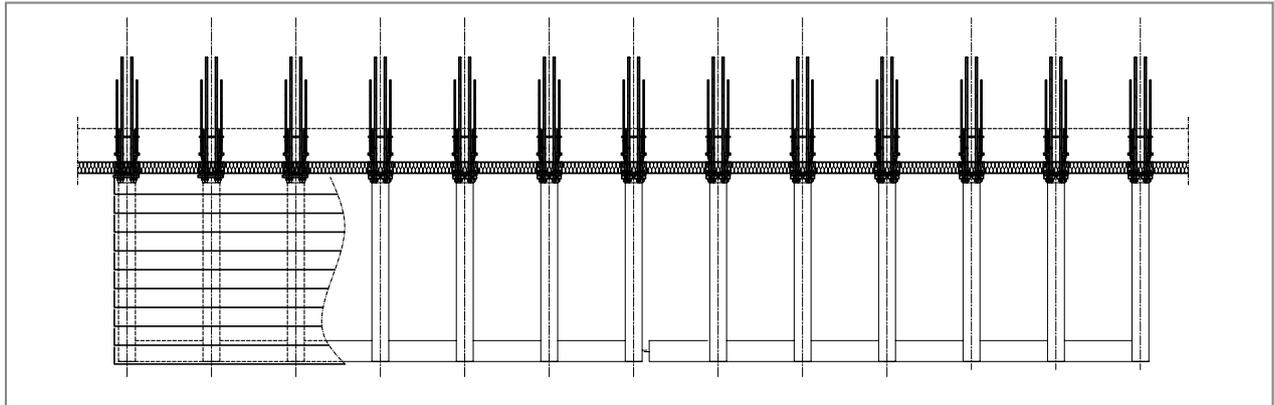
Schöck Isokorb® T type SK: Balcony freely cantilevered
